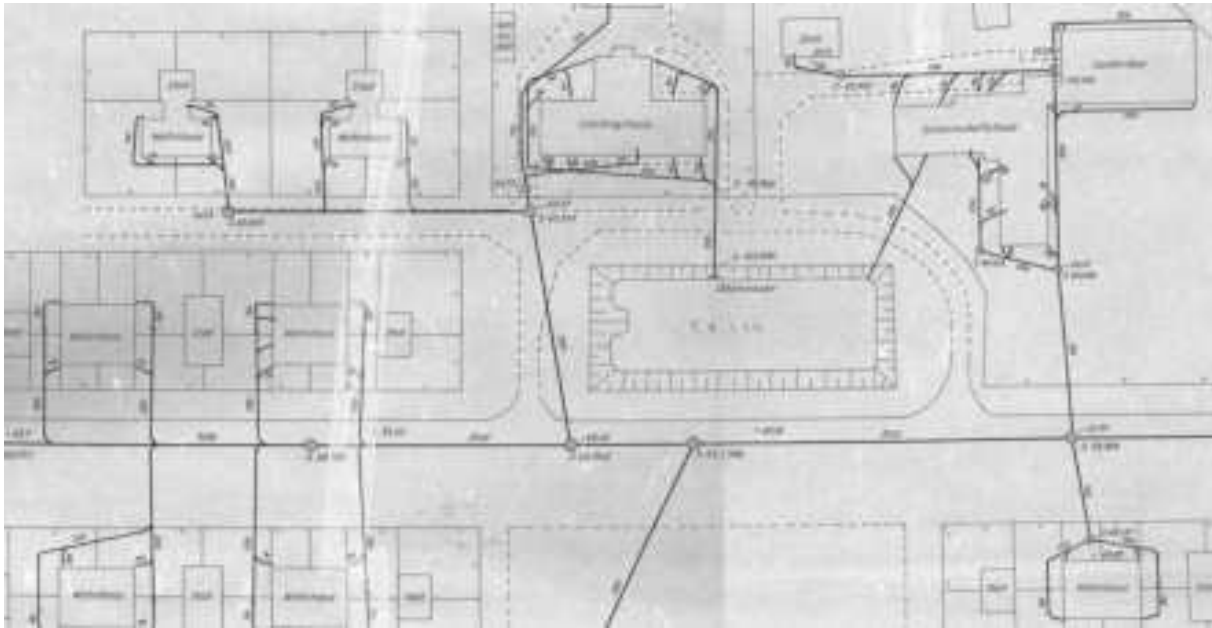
Ausschnitt Plan Entwässerungsanlagen, Stand 1960, Gemeinde Panketal
